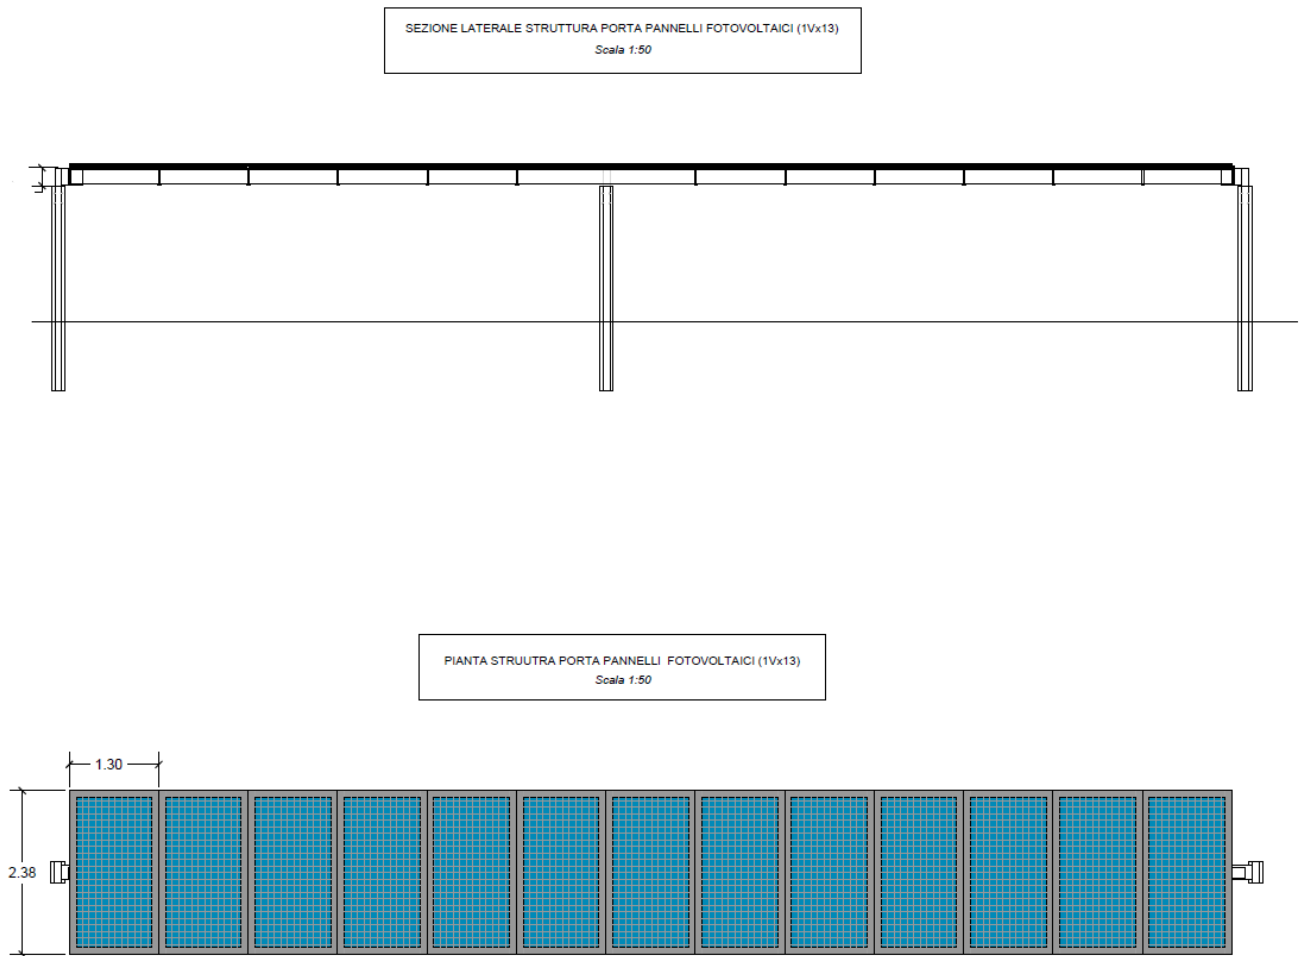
Schema della struttura – vista longitudinale e pianta 1vx13.
